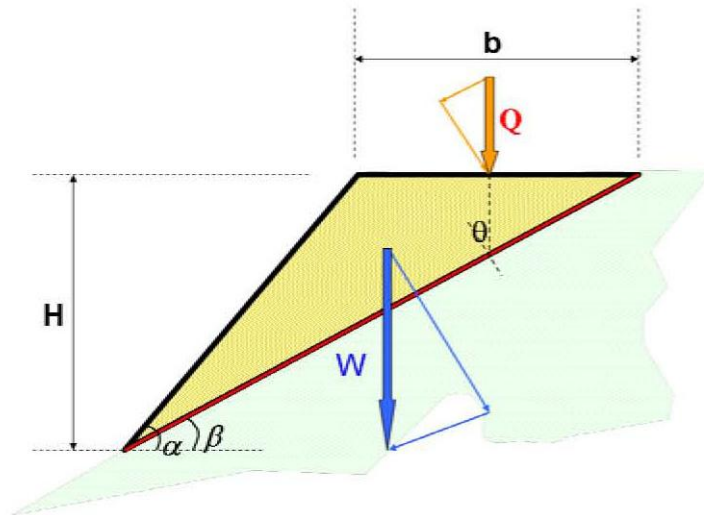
Schema delle forze nel caso di un sovraccarico a monte.
